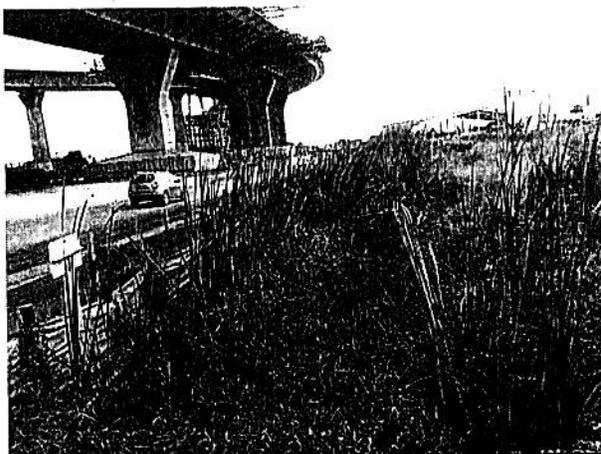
Canal Pasadena. Tramo descubierto. Invasión por vegetación en su cauce.
